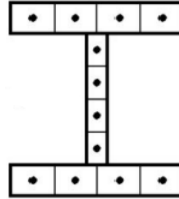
3: Disposición de las fibras en secciones viga-columna [74].
